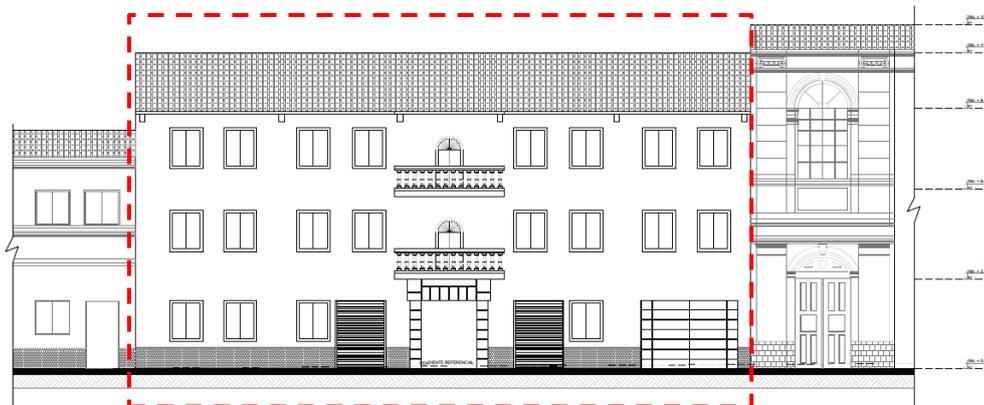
Fachada Urbana sobre la calle Vicente León, sentido Sur - Norte
